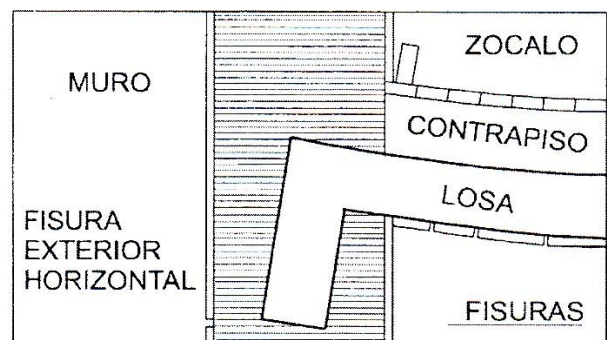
Inconvenientes ocasionados por las deformaciones excesivas de vigas de hormigón armado.
